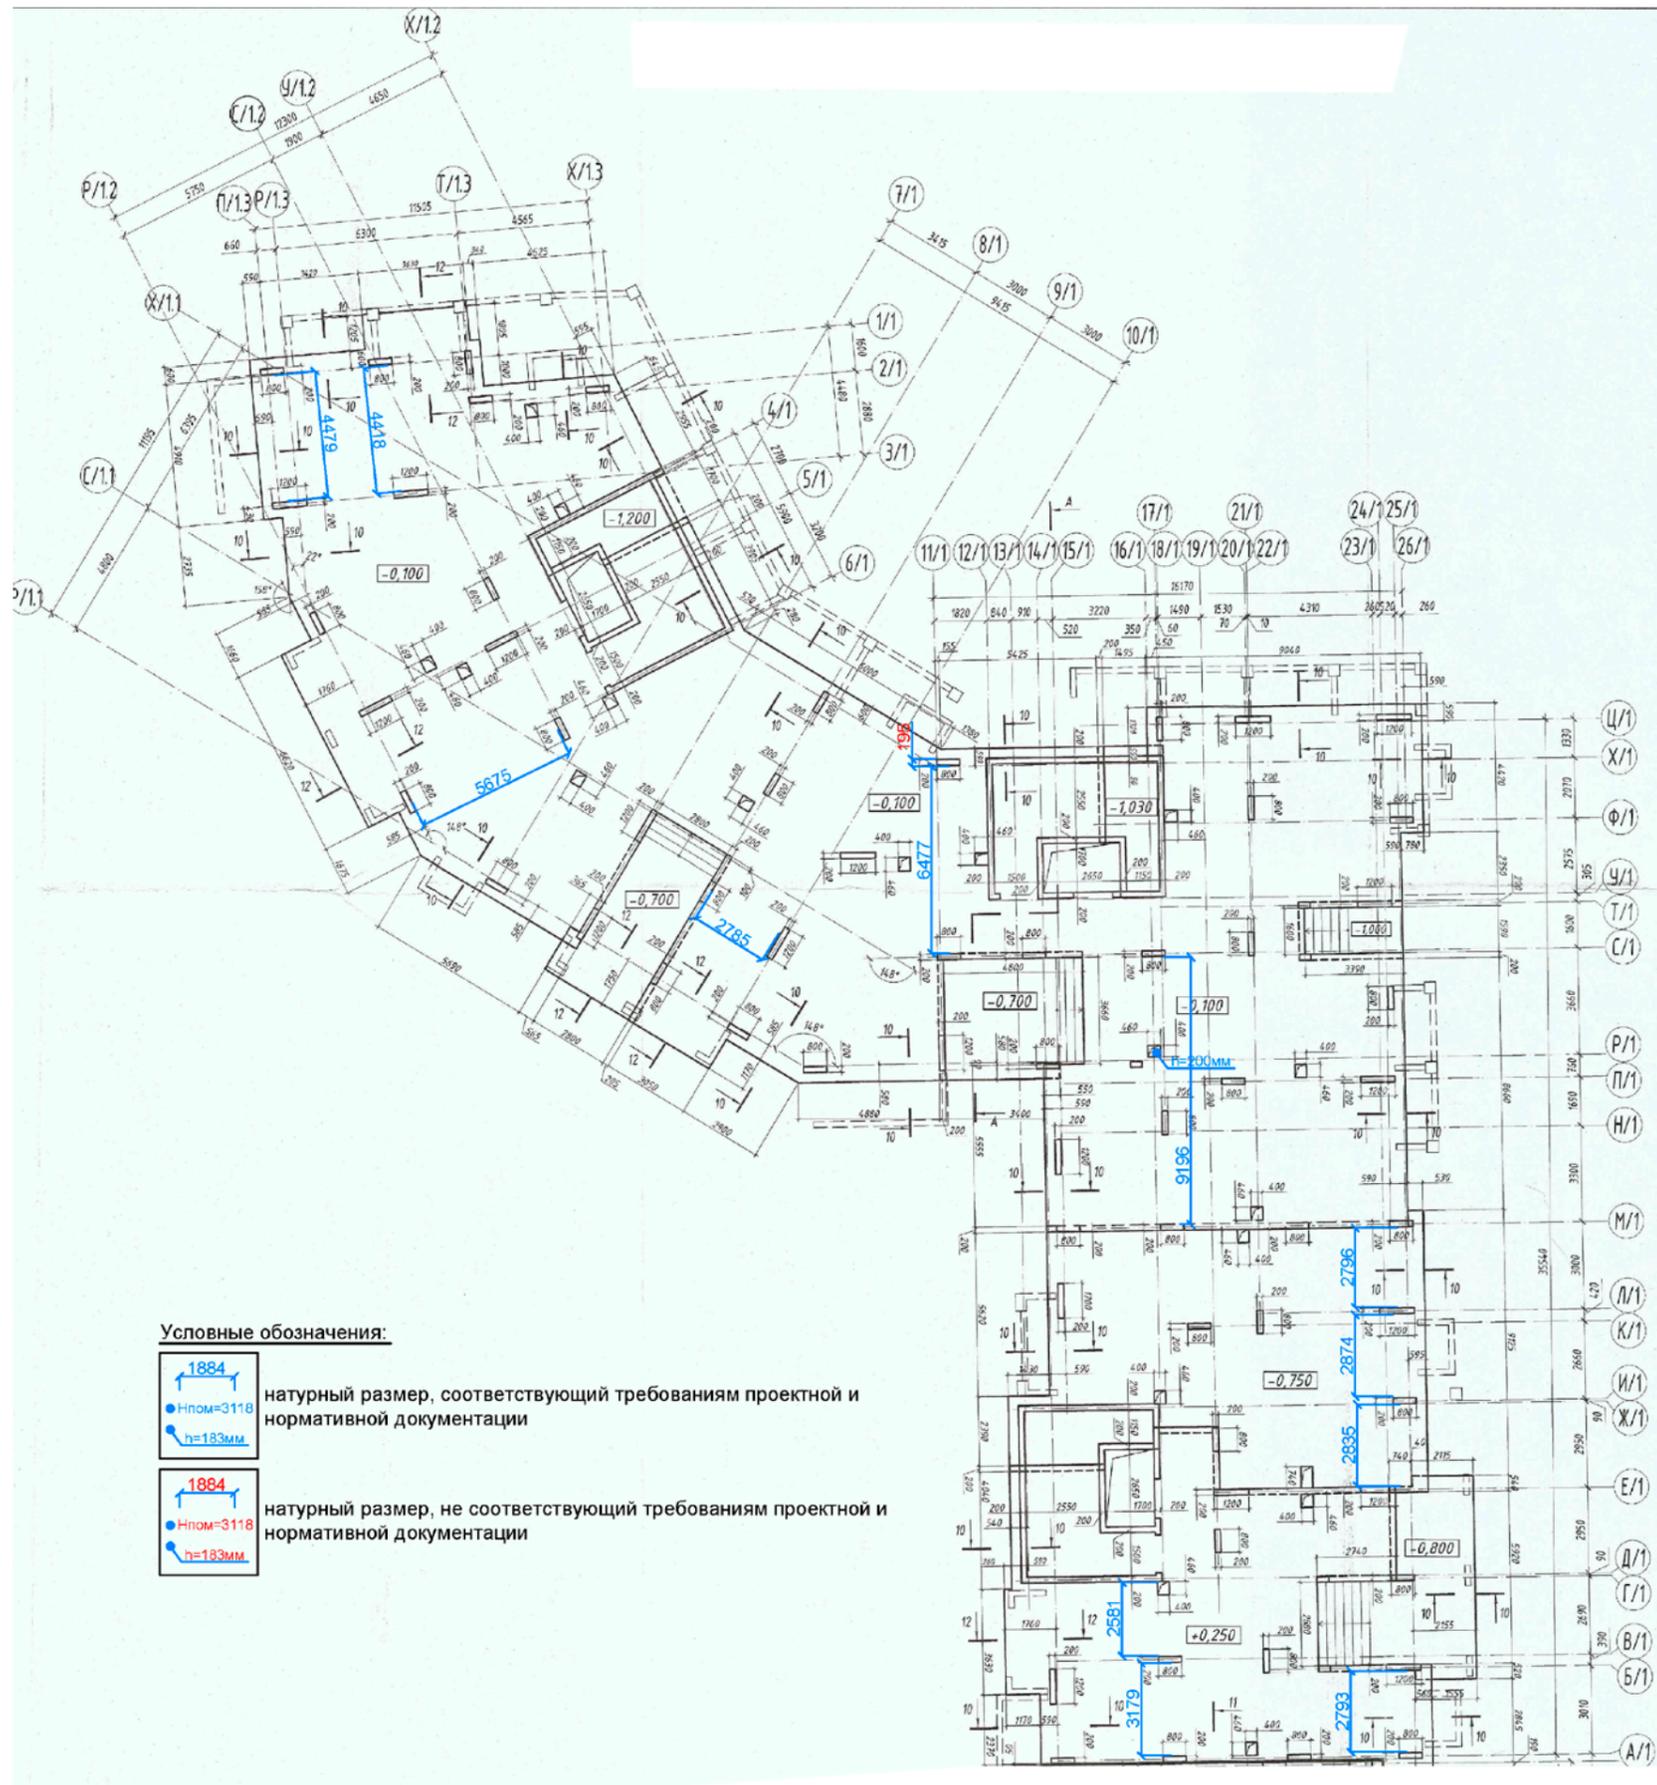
Обмерочный план плиты перекрытия подвала и монолитных конструкций 1 этажа 9,10,11 секции
